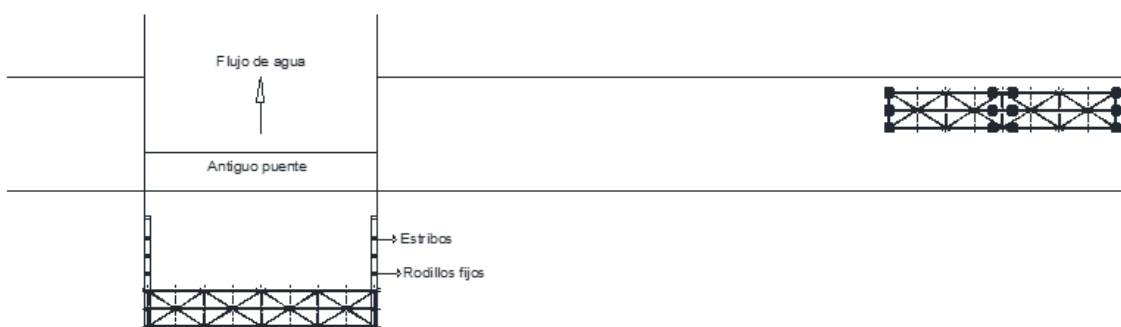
Movimiento transversal de las vigas metálicas mediante rodillos fijos
